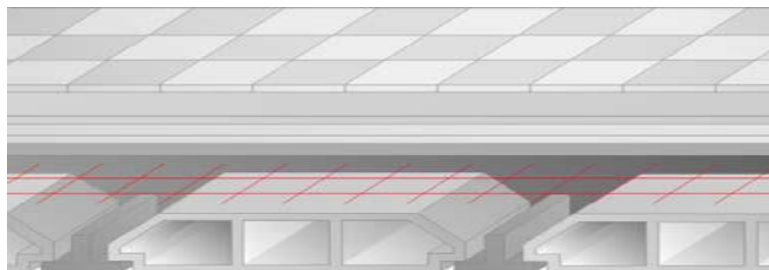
Coupe verticale du plancher étage courant à corps creux.
